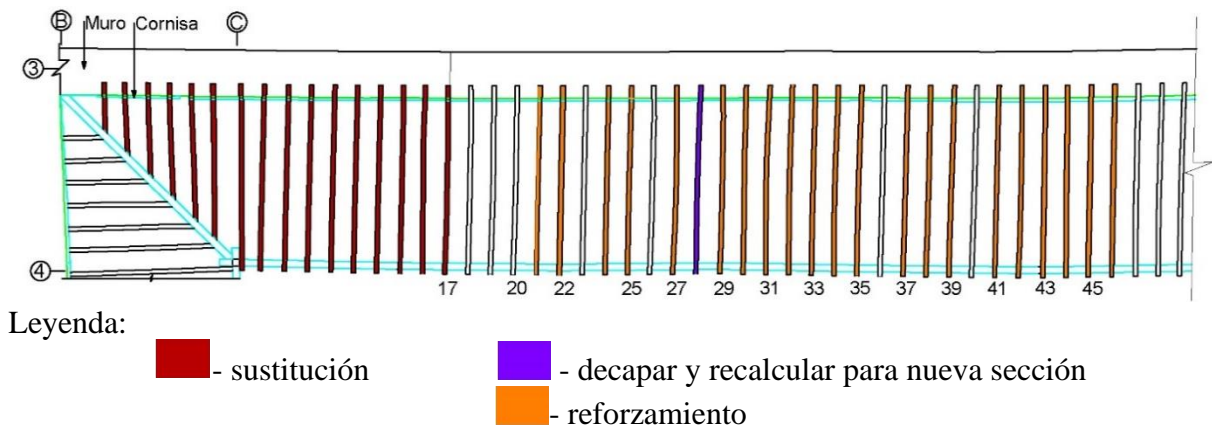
Propuesta de solución al forjado entre vigas 1-49
